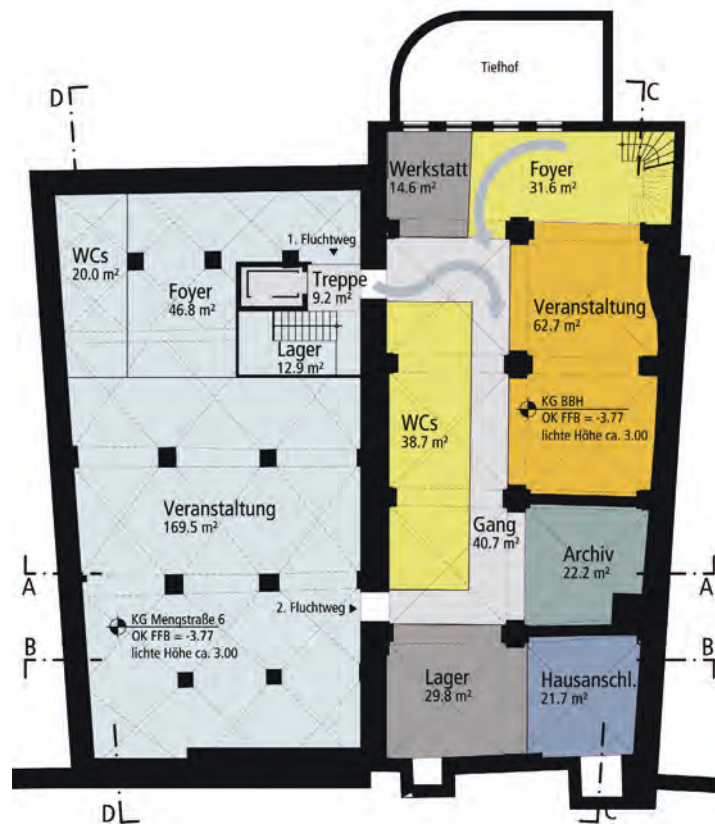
Variante 2, Grundriss Keller
